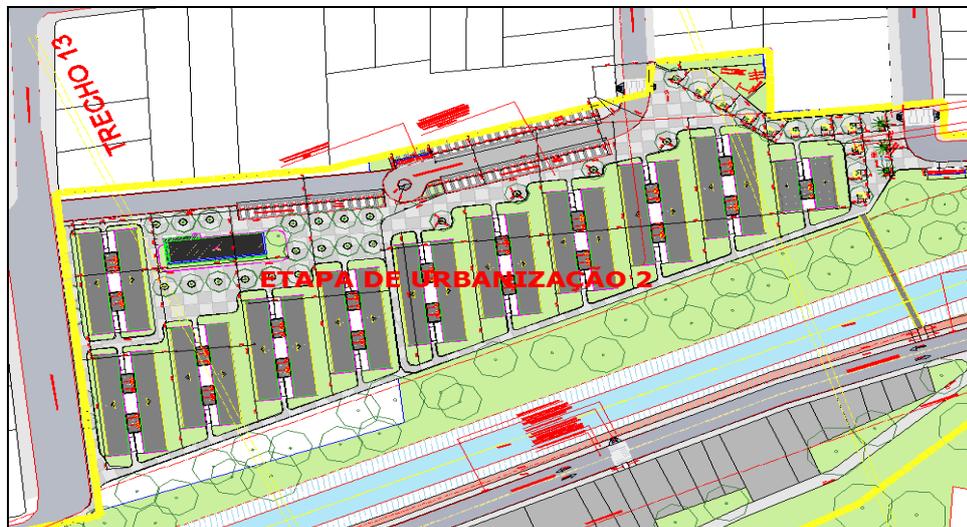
Planta de implantação dos edifícios no terreno (BESSA VELOSO).
